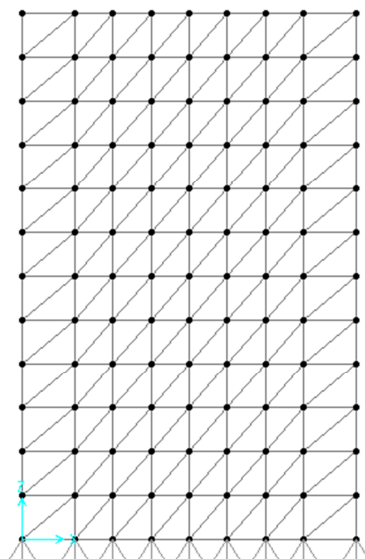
Configuração dos Planos de Contraventamento Vertical Com Elementos de Contraventamento Pequenos
